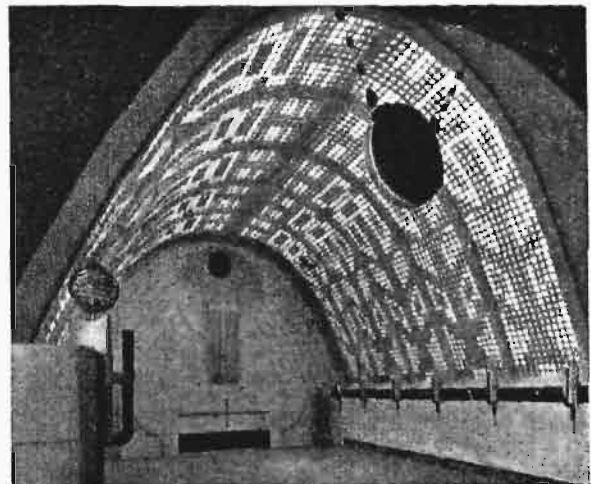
Widok zewnętrzny stropu żelbetowo-szklanego.
